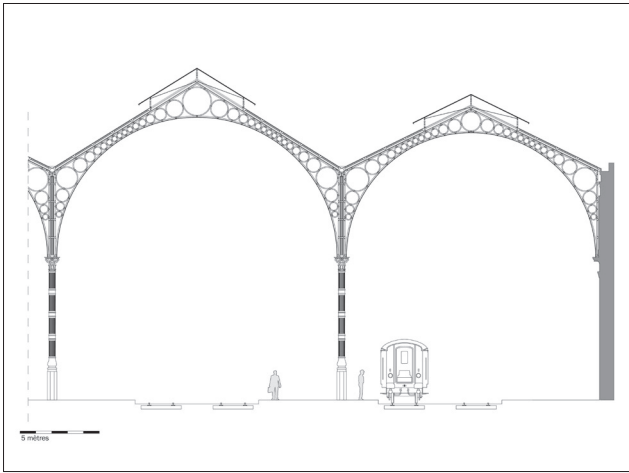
Coupe transversale de la halle de Bruxelles-Midi.
